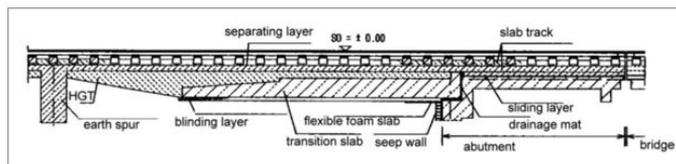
Medidas adicionales para las transiciones estructura-terraplén en sistemas de vía en placa, (FUENTE: Efficient Low Cost Renewal and Refurbishment Methods for Tracks in Tunnels and on Bridges and Viaducts (Urbantrack) [6])
